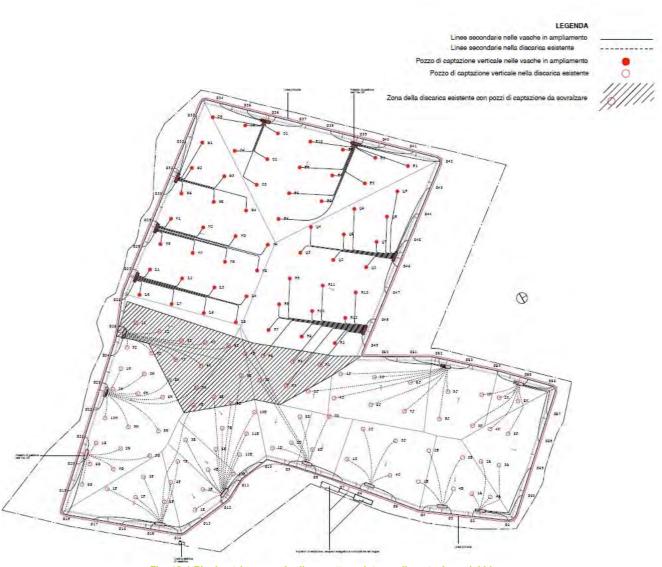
Planimetria generale di progetto - sistema di captazione del biogas
